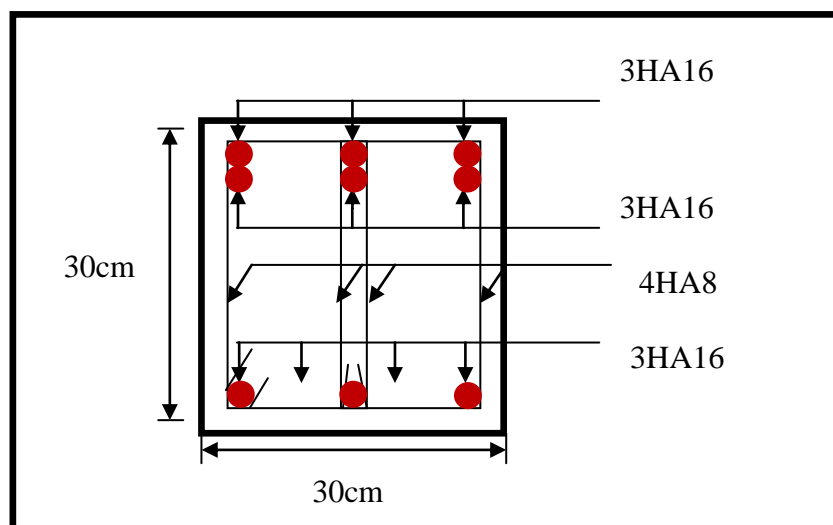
Ferrailage aux appuis d'une poutre secondaire
